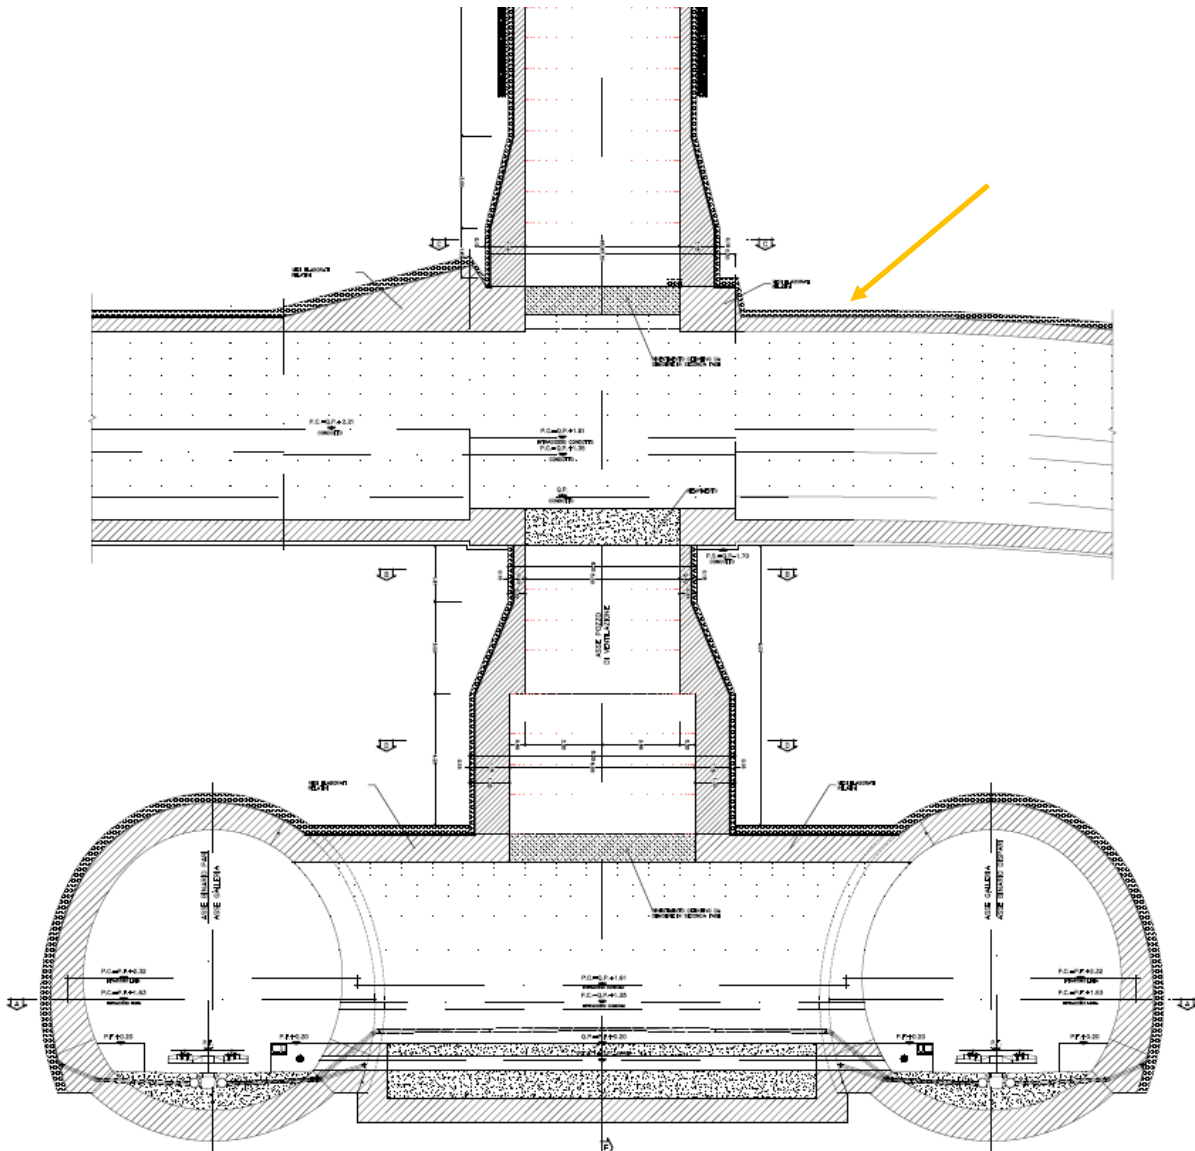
stralcio della planimetria del pozzo di aerazione GN17 secondo il progetto di Variante
